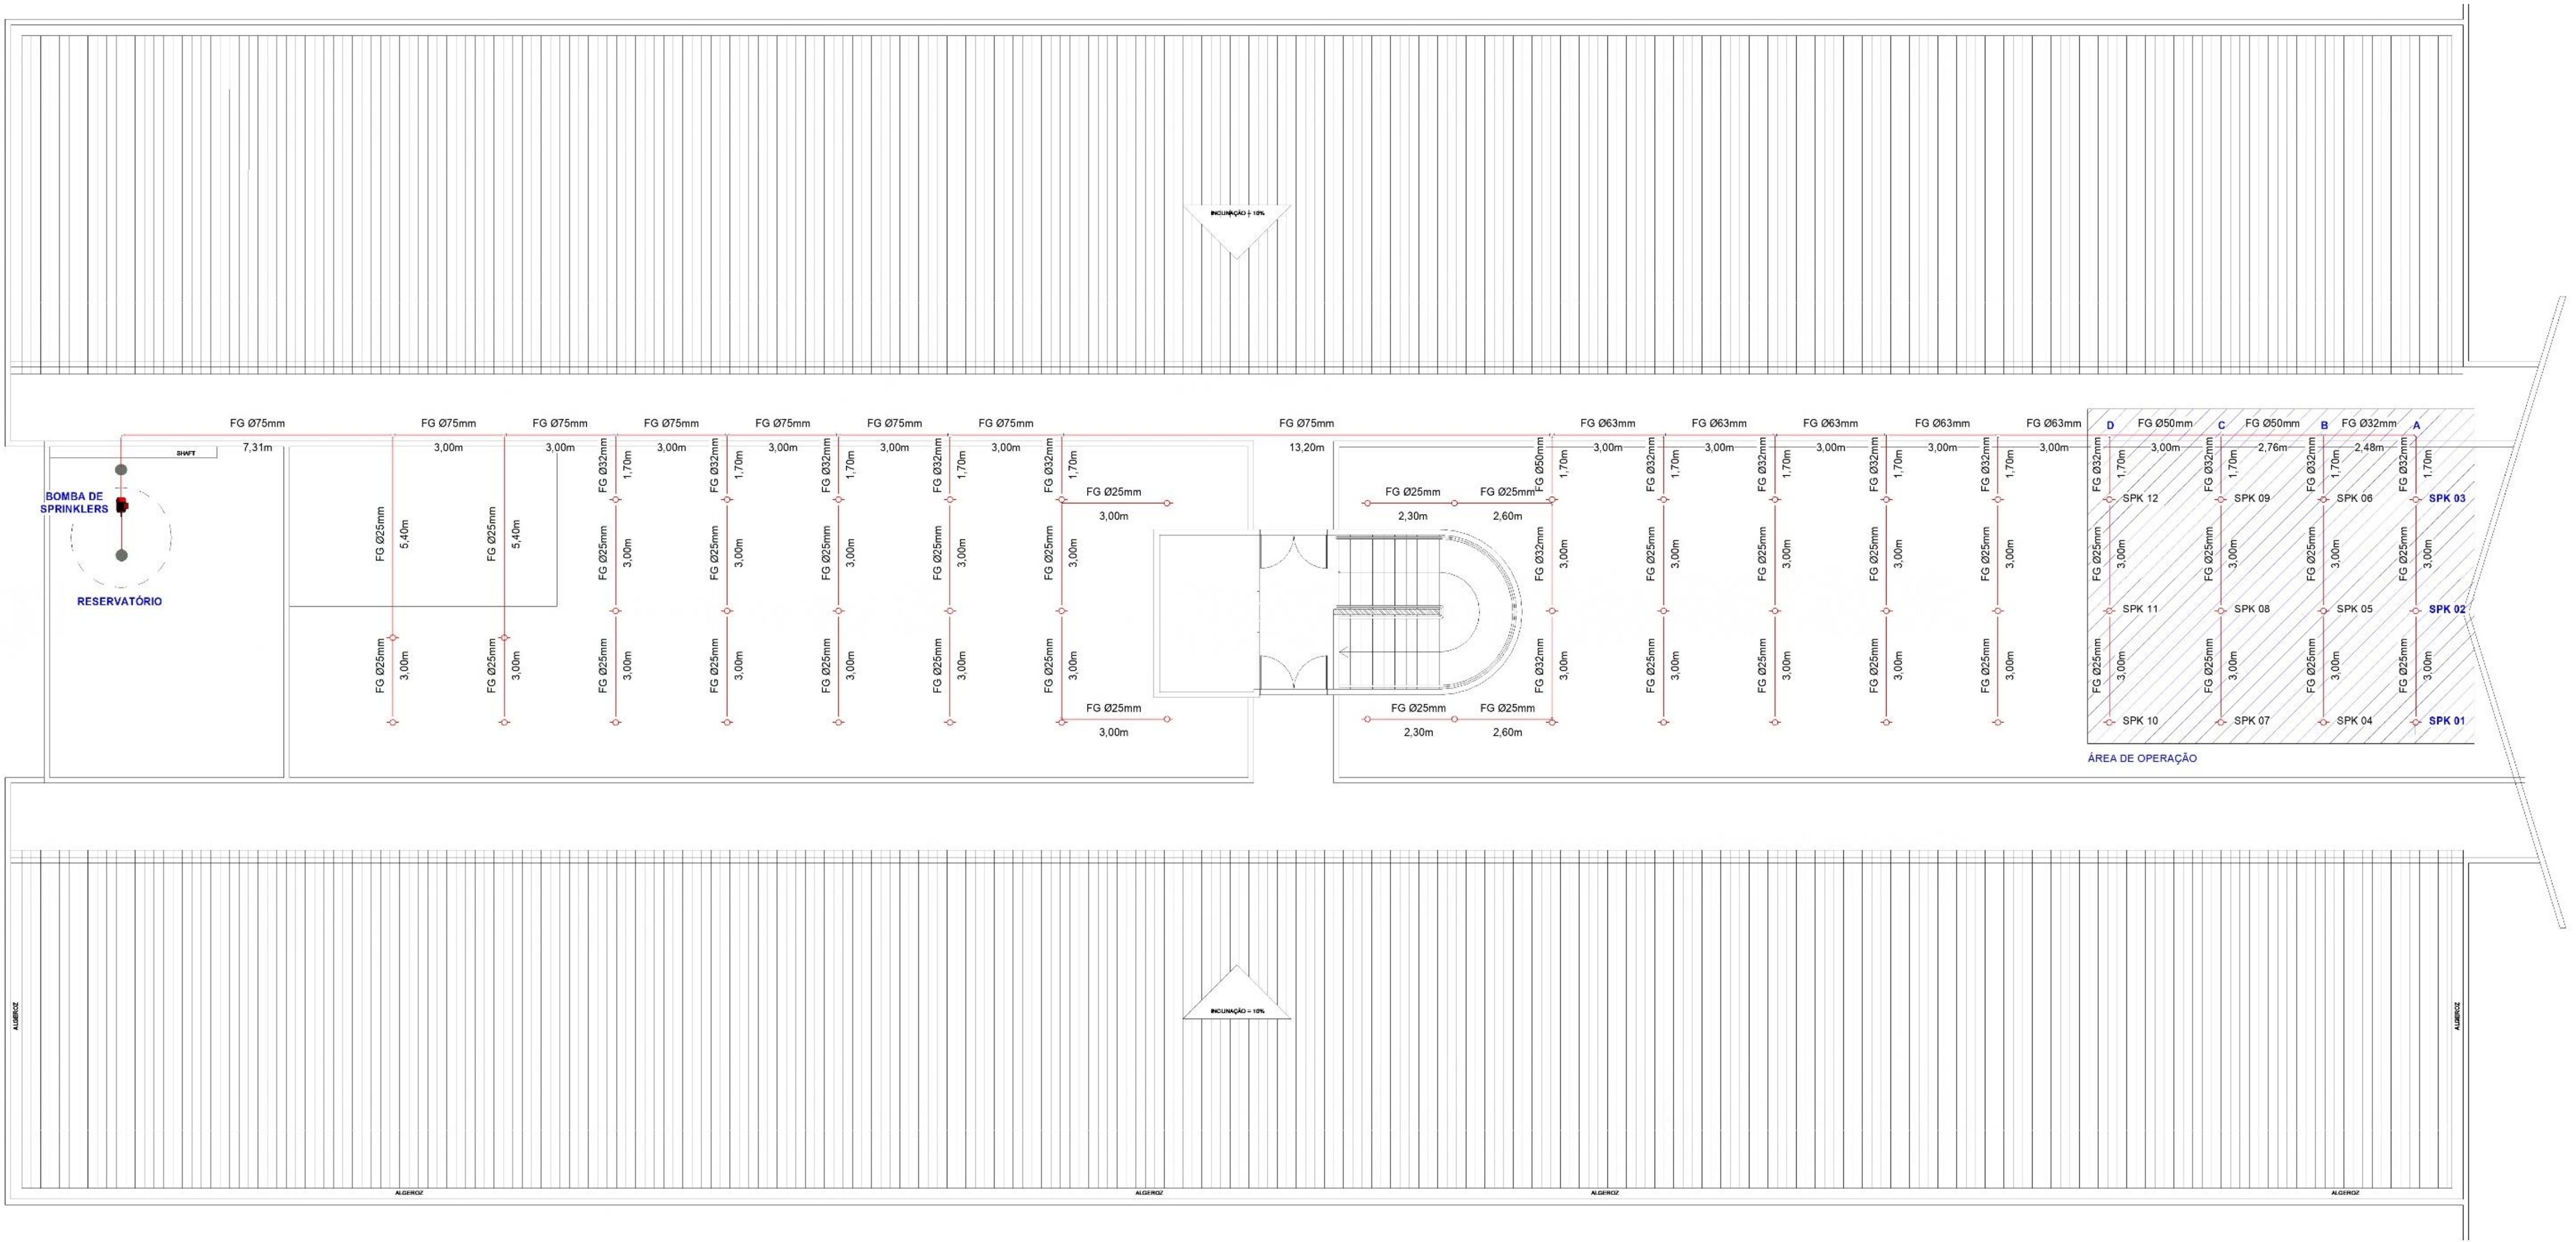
Planta Baixa do sistema de chuveiros automáticos do Centro de Engenharias I aplicado no Revit.
